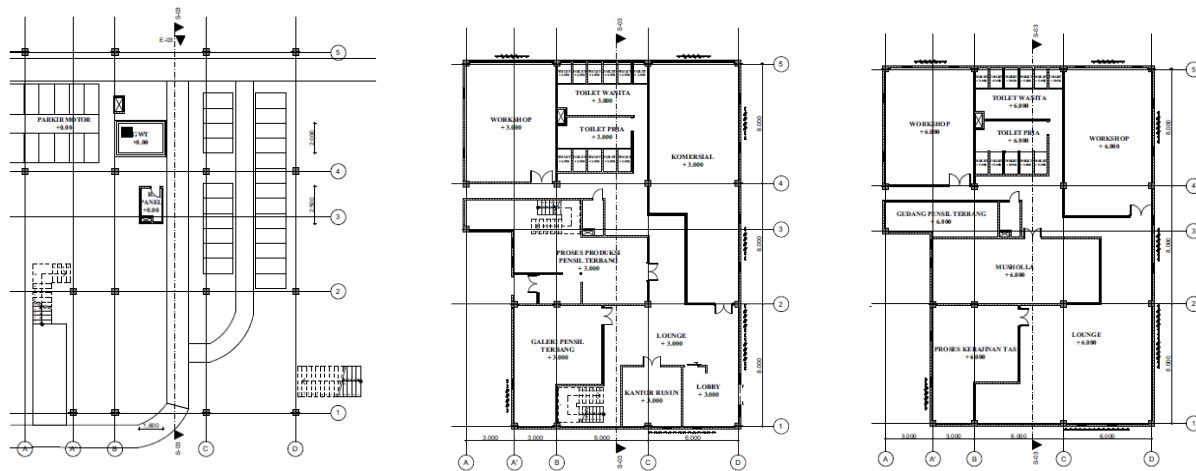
Denah LG – 3rd Floor Rusunami
